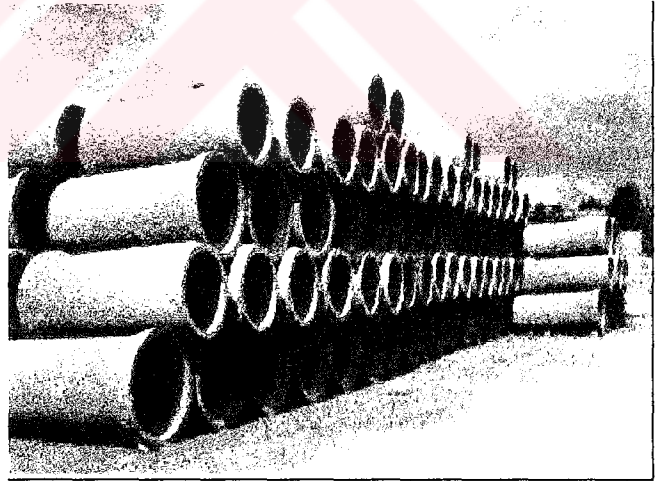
’de çelik tel donatılı bazı prefabrik beton ürünlerine ait örnekler verilmektedir.
